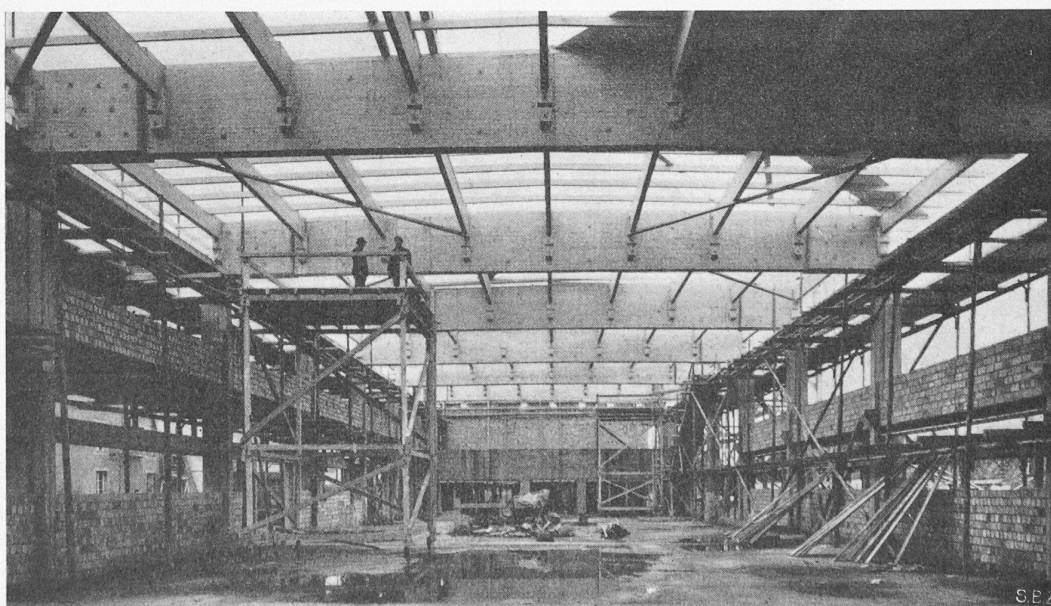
Rohbau. Man beachte die Dachkonstruktion aus Holz
